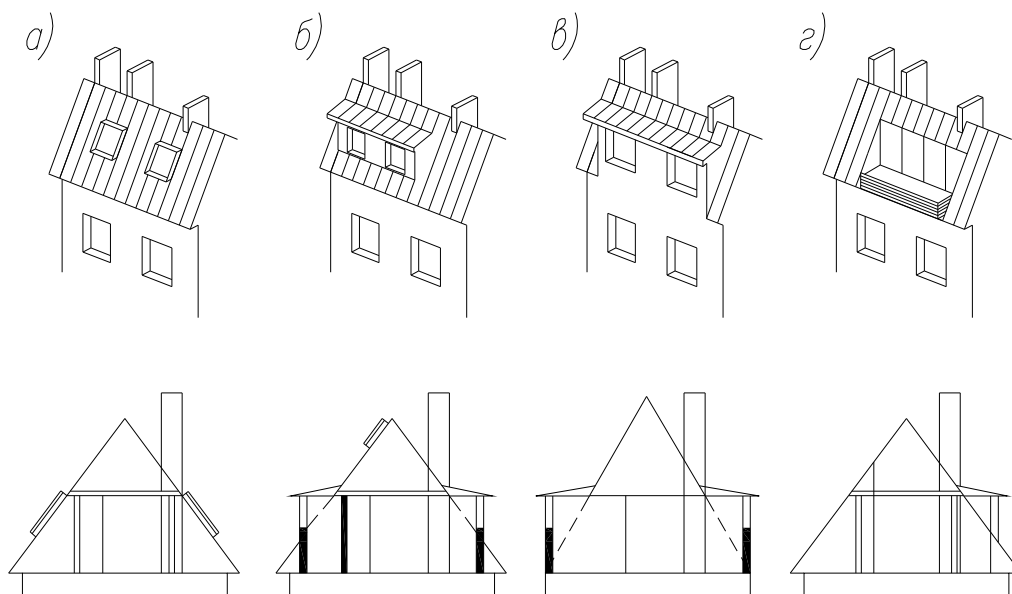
Размещение оконных проемов в крышах зданий с мансардами: а – в плоскости ската крыши; б – вертикально с выдвижением оконной коробки из плоскости крыши; в – то же, с наращиванием наружной стены здания; г – то же, с задвижкой оконных блоков в глубь помещения и устройством балконов
